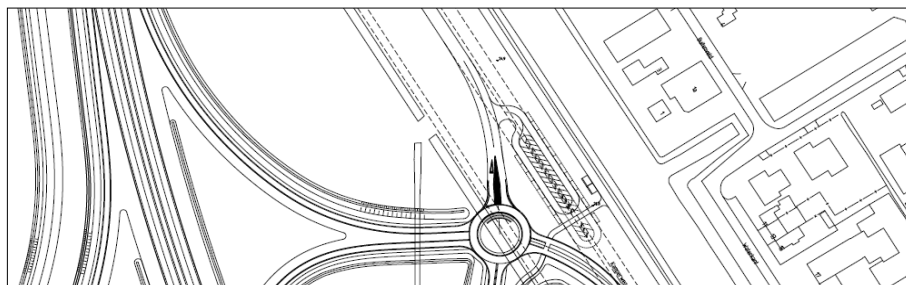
Ontsluiting uitbreiding bedrijventerrein ten noorden van Ens
